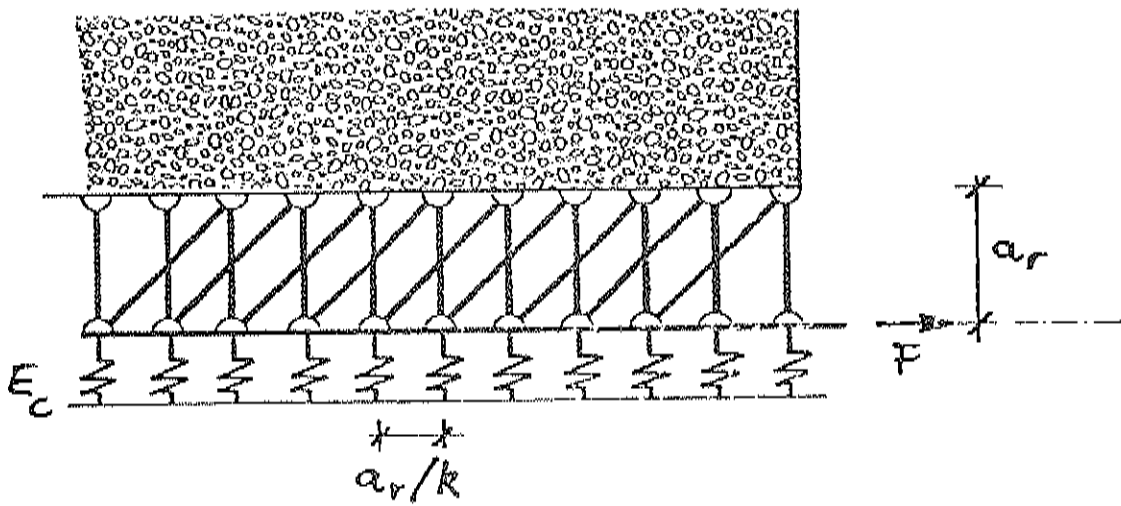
Schematizzazione di un incollaggio acciaio - calcestruzzo mediante traliccio iperstatico /5/.
